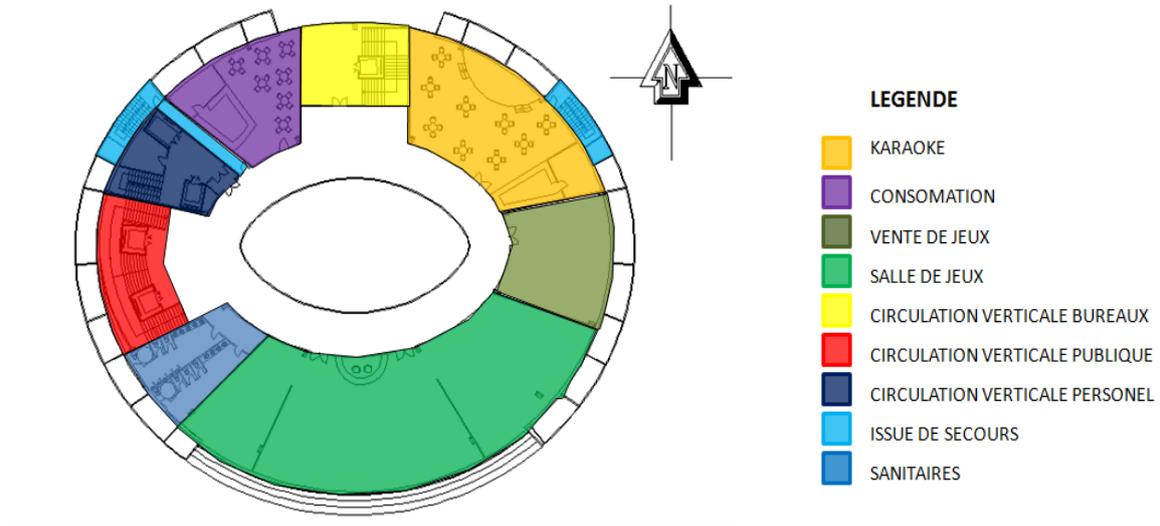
Plan traité du 2ème étage au niveau +10.20.
